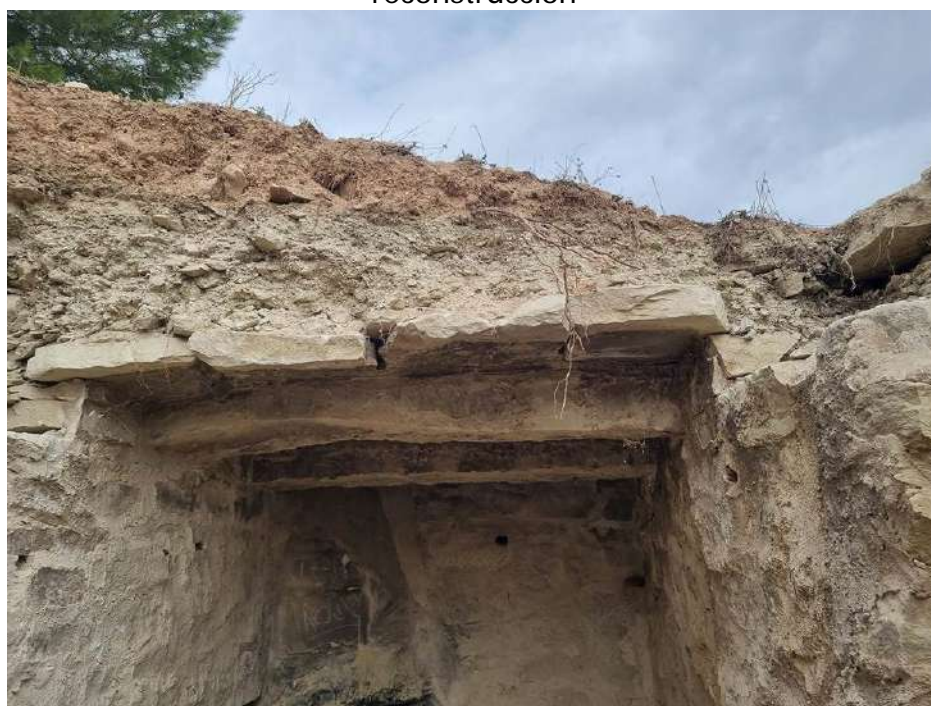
Sección refugio, una vez saneada la cubierta cedida
